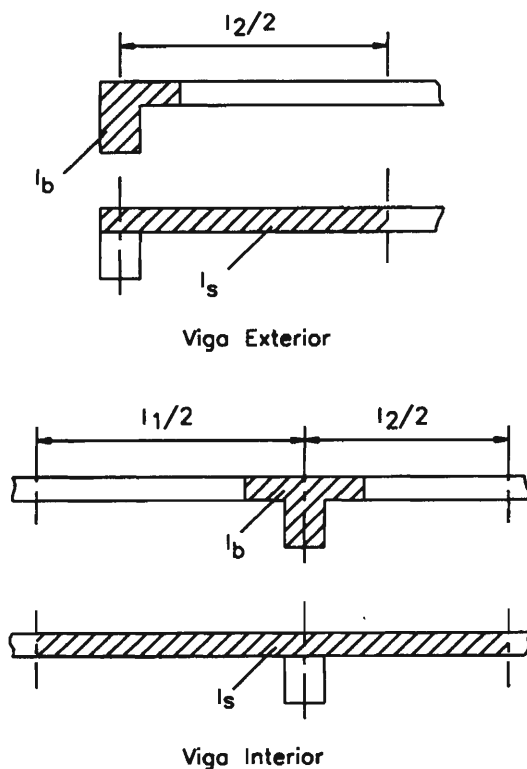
Secciones de losas y vigas a ser consideradas para el cálculo de la expresión
